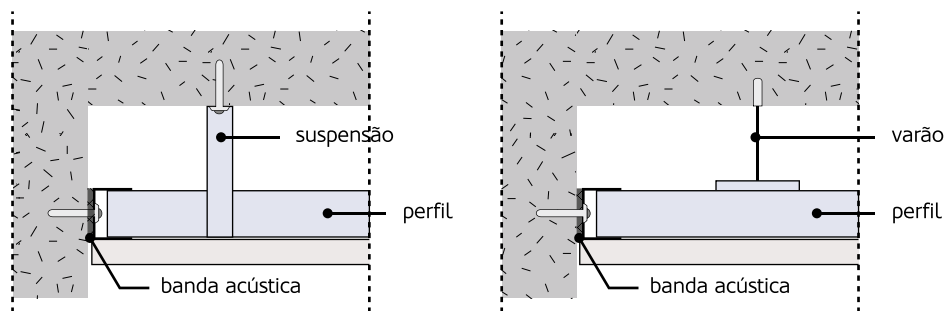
Aplicação de banda acústica entre o suporte e o perfil perimetral.
